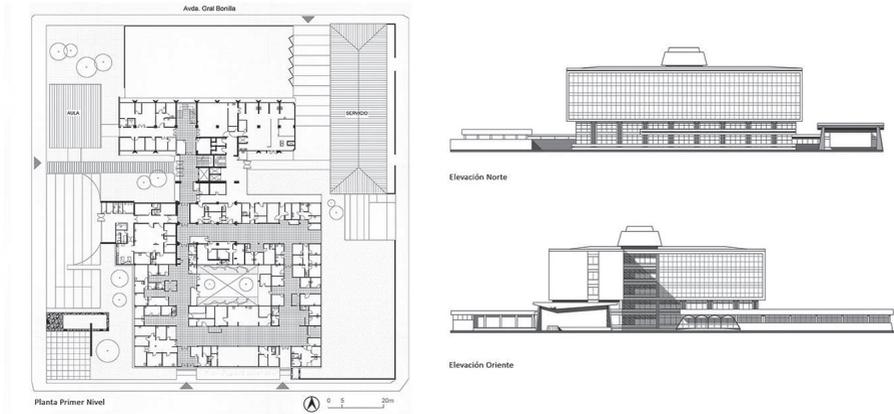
Hospital Dr. Mauricio Heyermann, Angol. Izq. Planta primer nivel. Der.: Elevación norte y oriente. Fuente: *Revista de la Construcción*, 1964, pp. 86-87. Dibujo: Bárbara Sáez Orrego.
